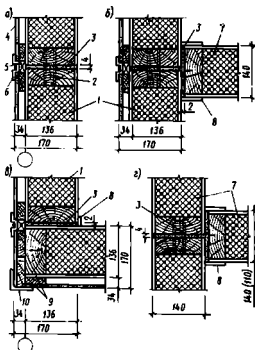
Конструкция вертикальных швов в клефанерных панелях наружных и внутренних стен:
